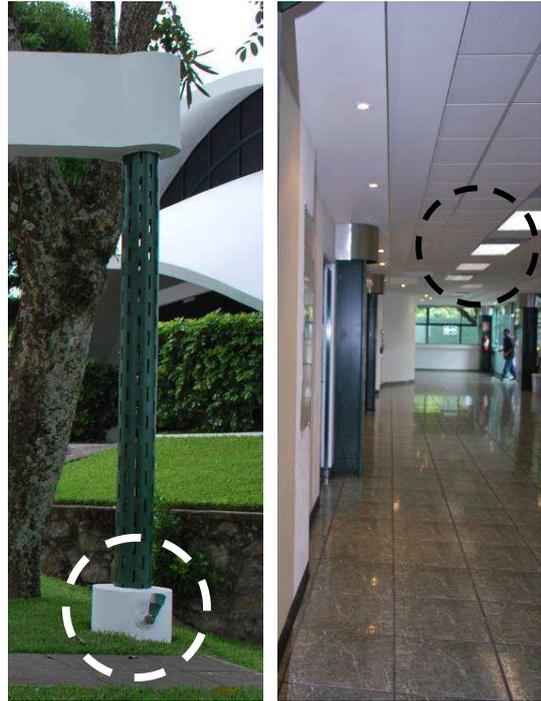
(Izquierda) Muestra el detalle de iluminación en columnas, para realzar el detalle arquitectónico.
